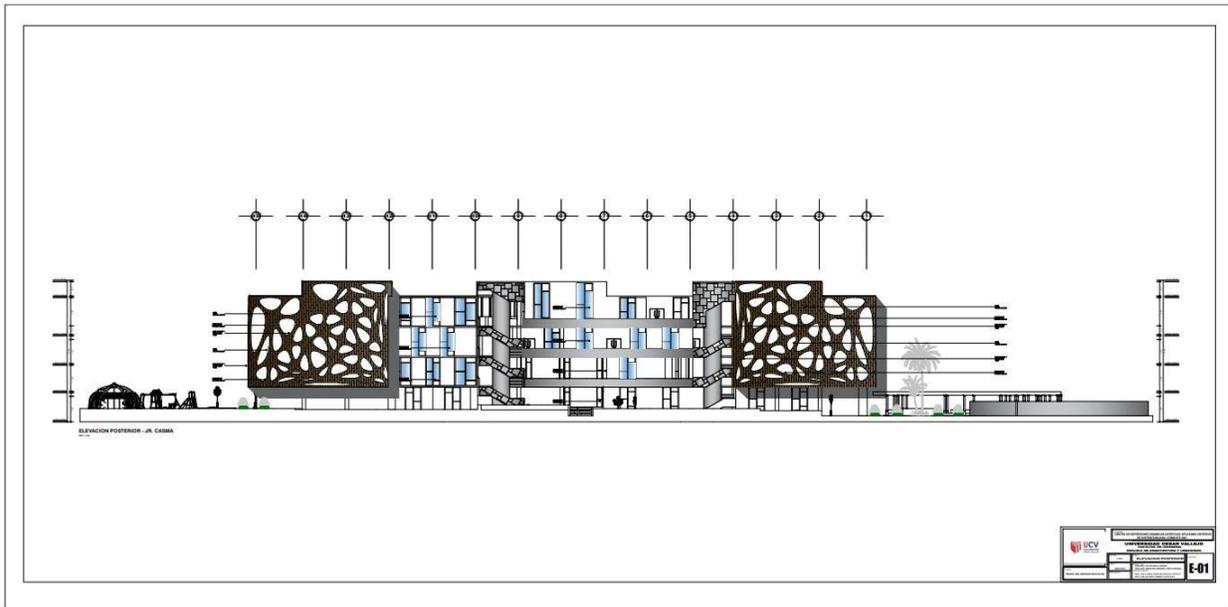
Plano Elevación Posterior. Fuente: Elaboración Propia
